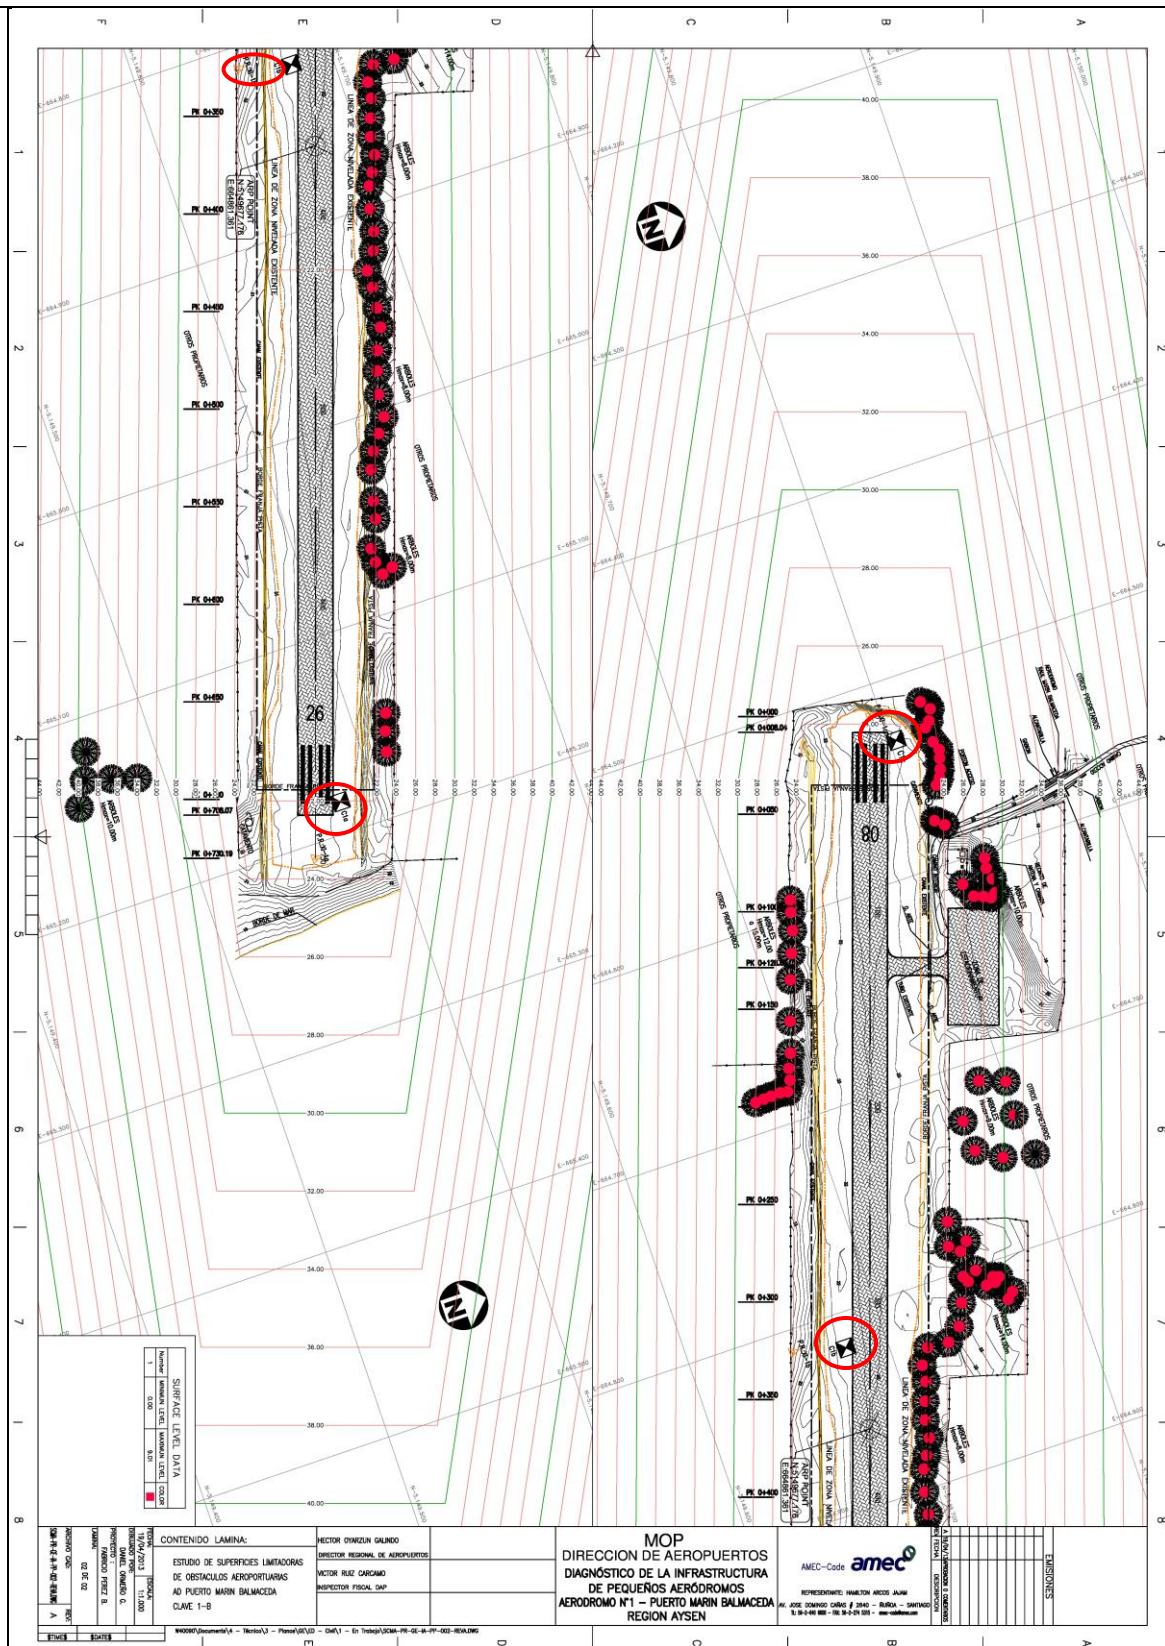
UBICACIÓN EN PLANTA DE CALICATAS
